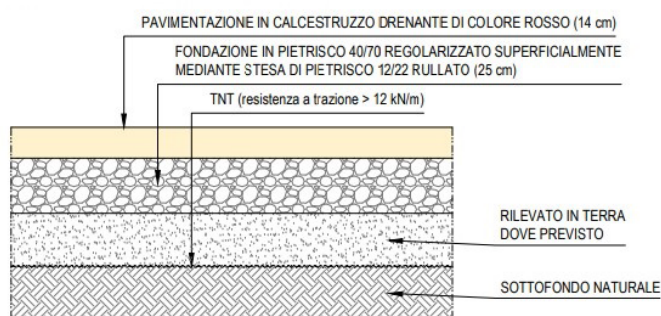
Dettaglio pavimentazione ciclabile in calcestruzzo drenante
